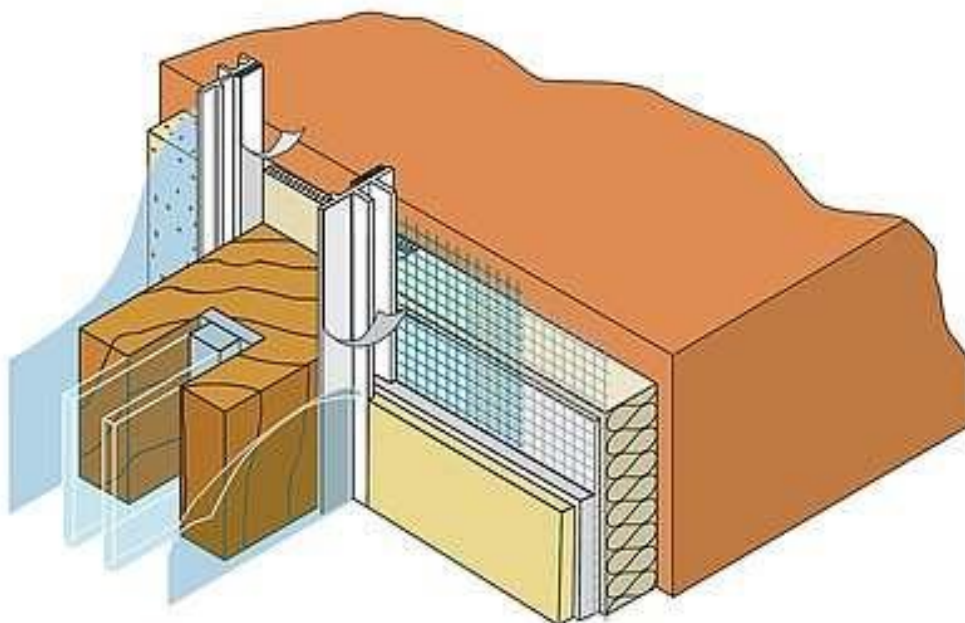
SYSTÉMOVÁ LIŠTA NADPRAŽÍ
